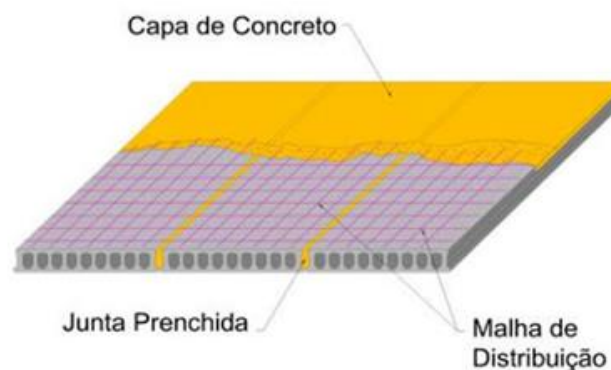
Painéis solidarizados, malha de distribuição e capa de concreto (RBR Pré-Moldados, 2018).
